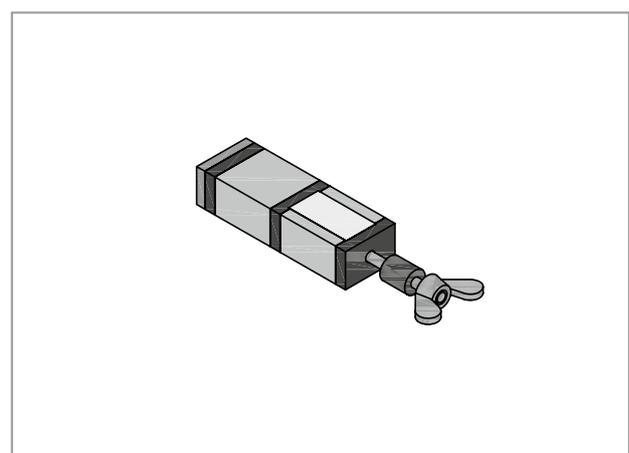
Schöck Tronsole® Typ Q: Montageelement
